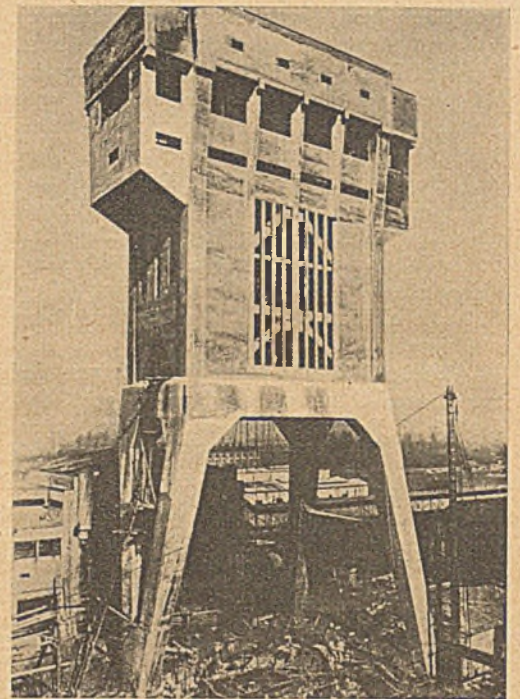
Eisenbeton-Förderturm mit Dreipunkt Lagerung.
